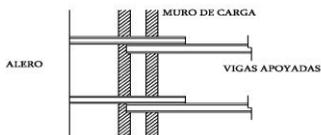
Apoyo de viguetas tipo 1, con cierta continuidad. Año 2012. Fuente: elaboración propia.
